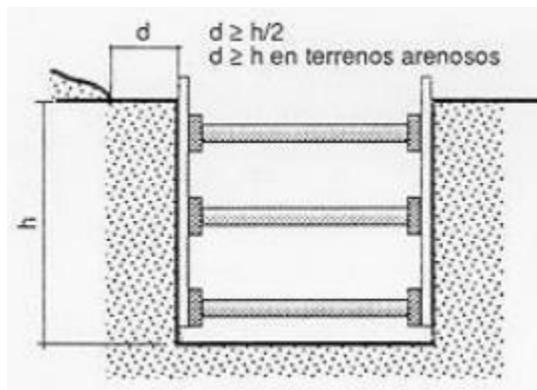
Distancia de colocación del material excedente sobre la zanja de excavación.
